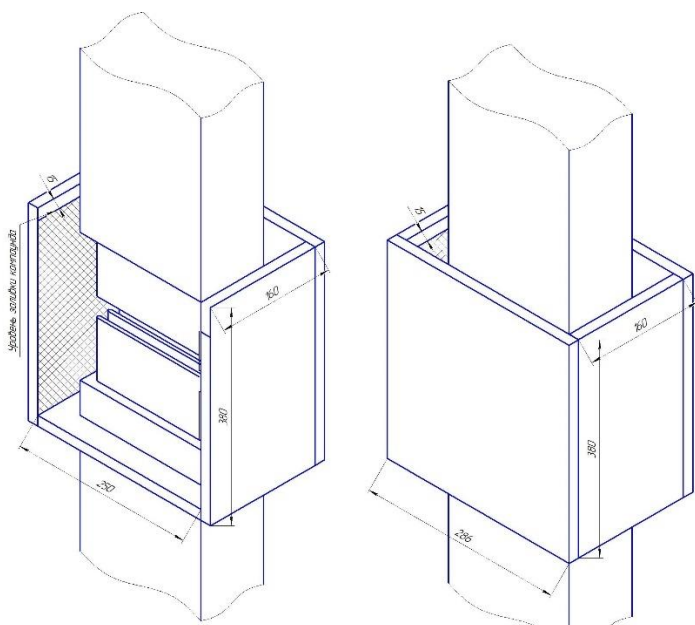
Монтаж опалубки при заливке шинпровода смонтированного вертикально (размеры приведены для шинпровода на 1600 А).
